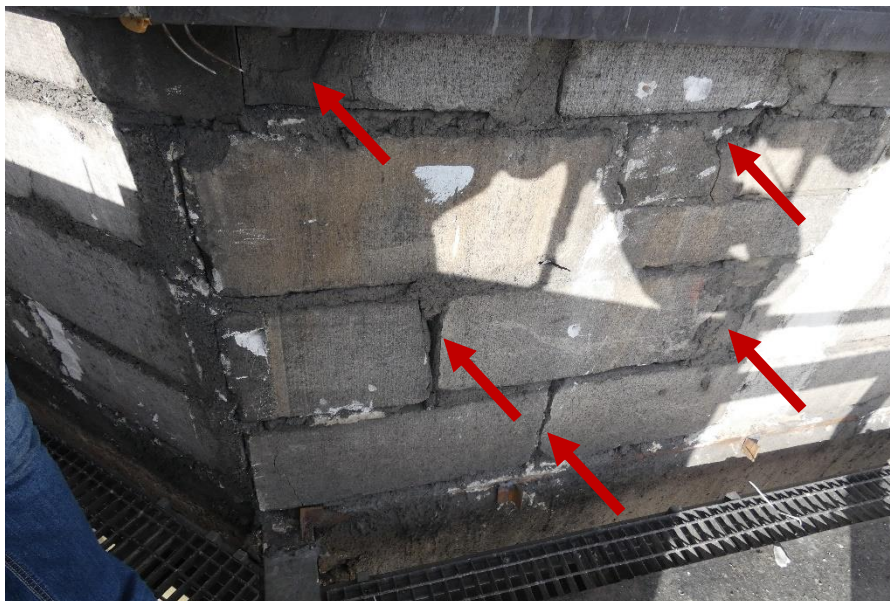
Widok pionu instalacyjnego zamkniętego zaprawą i gruzem
